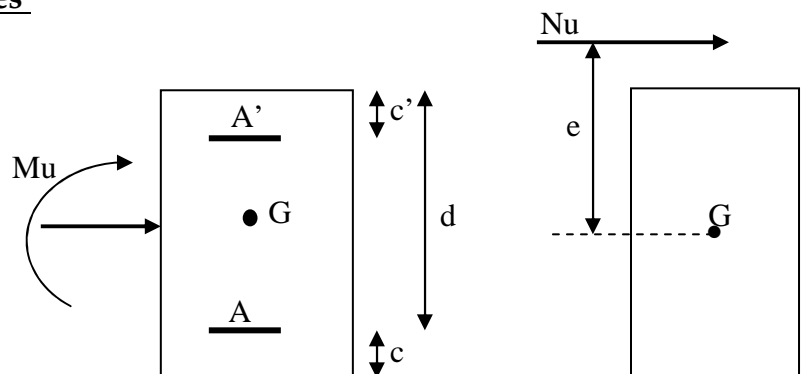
Les moments exerçant sur les poteaux
